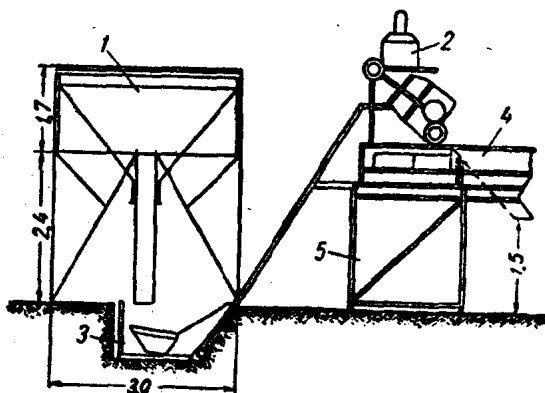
混凝土攪拌機設在台上時，調制混凝土混合料的圖式方案
